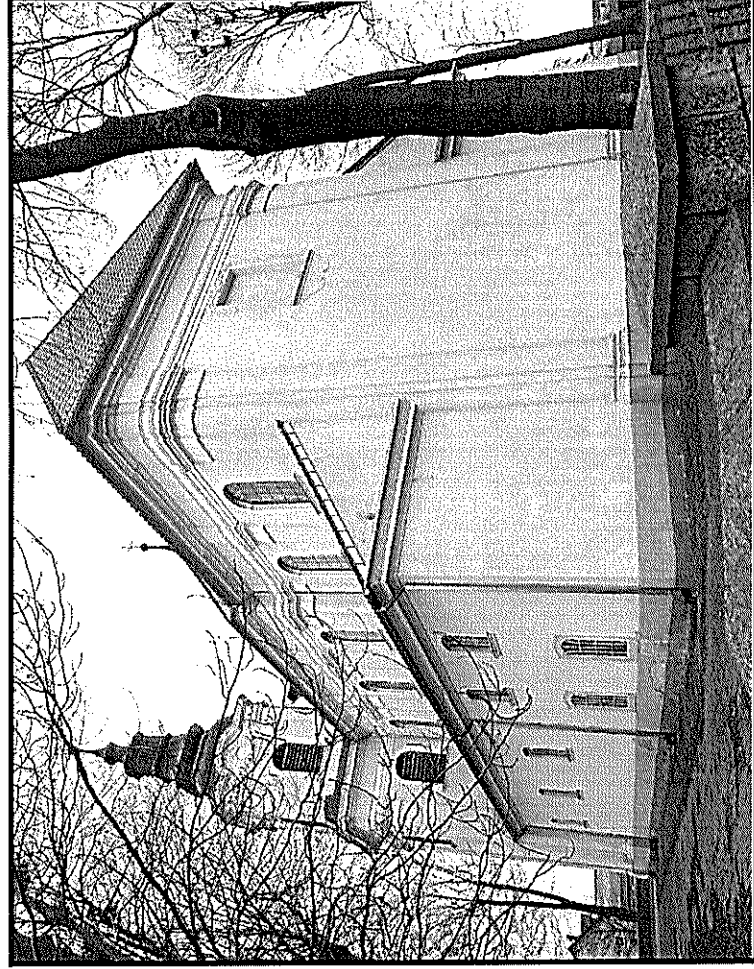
Zły stan zachowania cokołu elewacji wschodniej kościoła w Regnowie.
